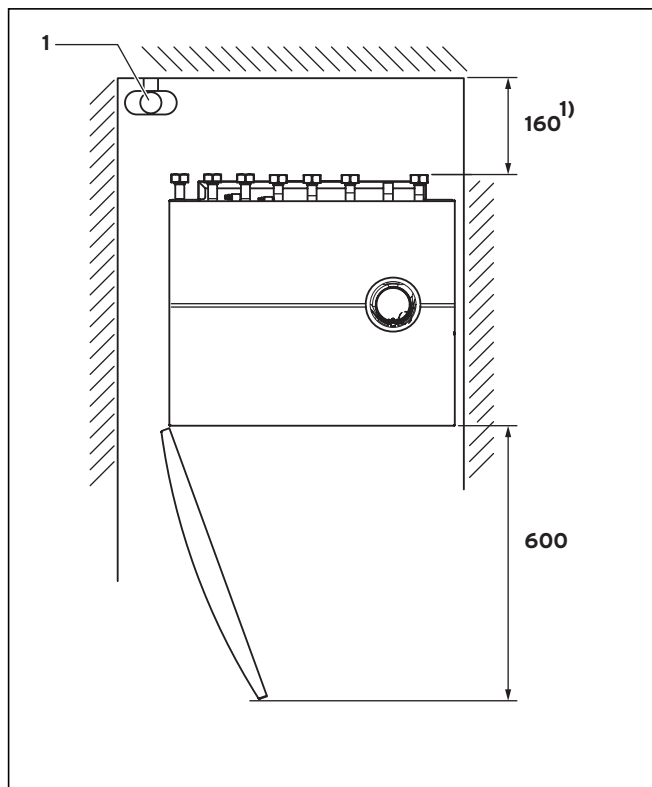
Distanze richieste per l'installazione (misure in mm)
